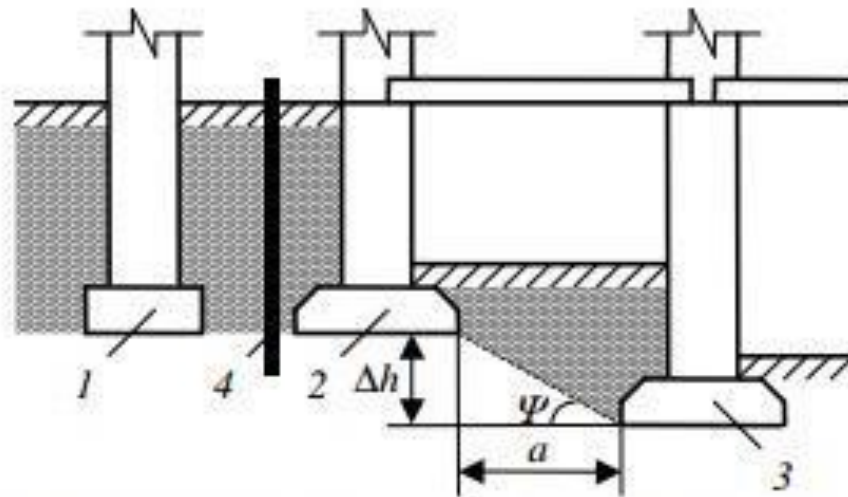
Схема захисту існуючої будівлі від додаткових осідань при зведенні поряд нової будівлі з більшою глибиною закладання фундаментів: 1 – фундамент існуючої будівлі; 2 – фундамент нової будівлі; 3 – фундамент з більшою глибиною закладання; 4 – шпунтова стінка
